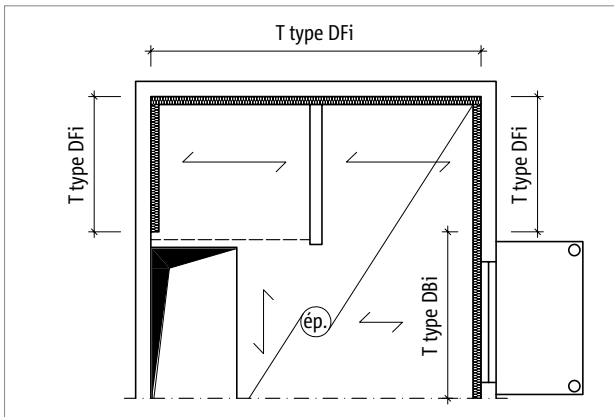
Schöck Rutherma® T type DF_i : utilisation entre la dalle et la façade
